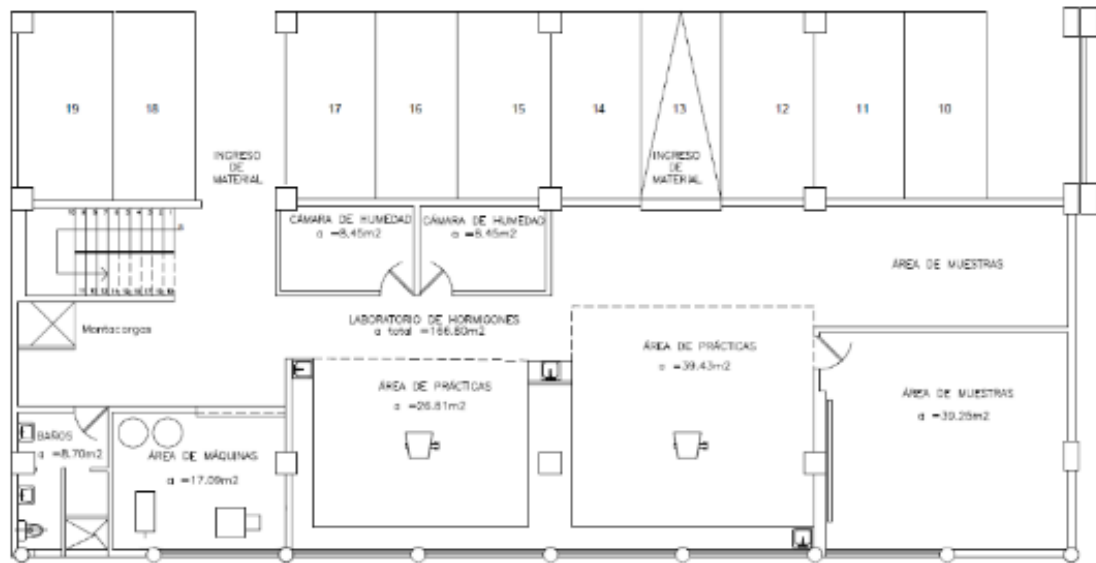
Plano General / Planta Alta Edificio Nuevo Laboratorio de Ingeniería
